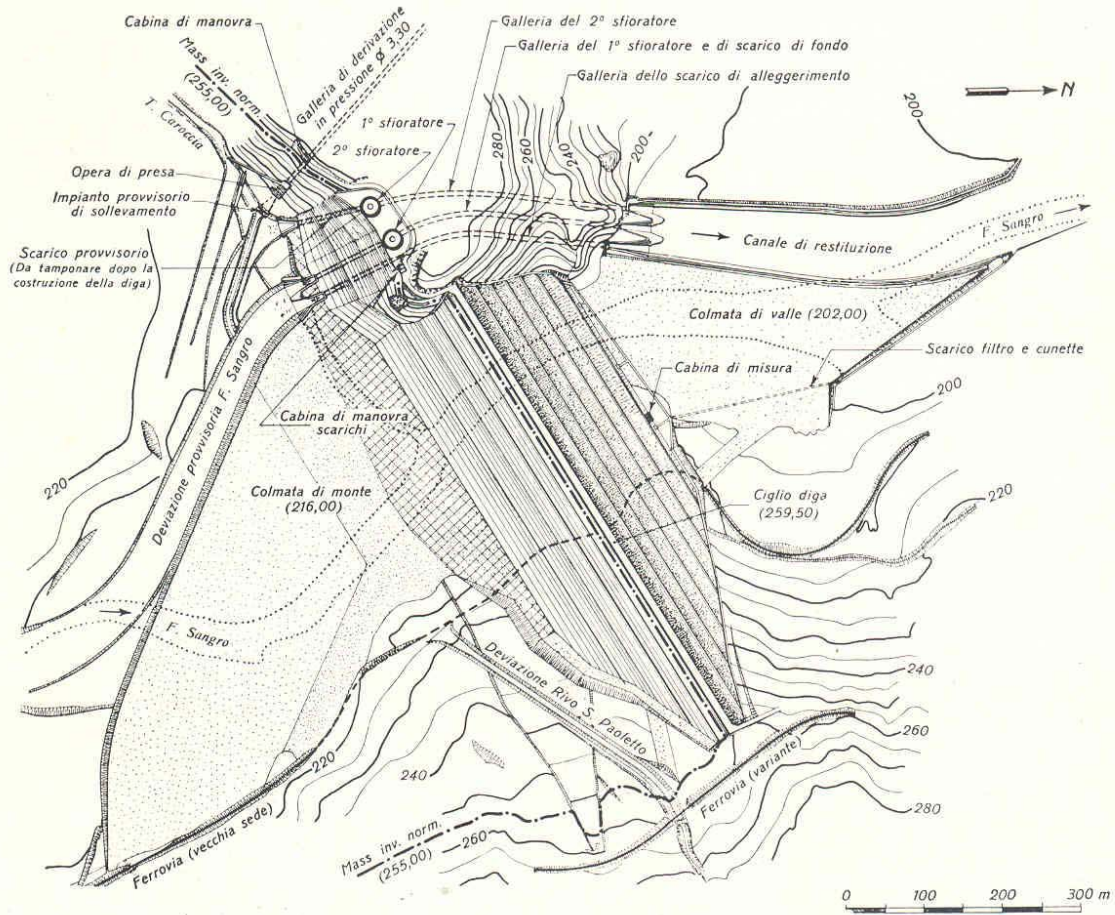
DIGA DI BOMBA SUL SANGRO -- Planimetria generale.
